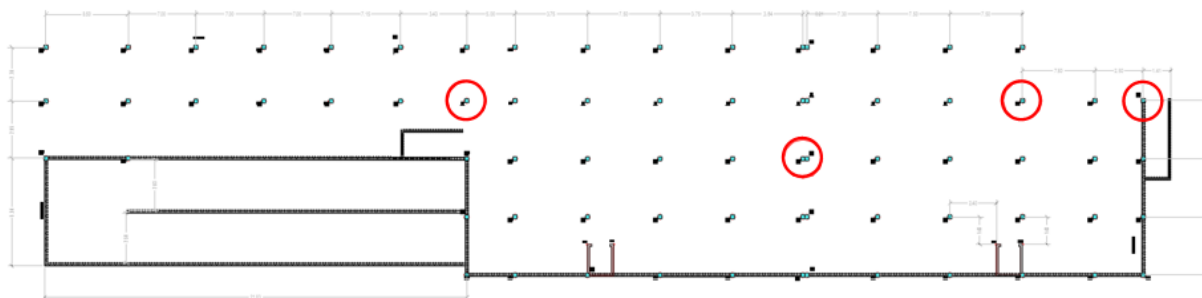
Implantação dos pilares em planta no edifício da Lousã
